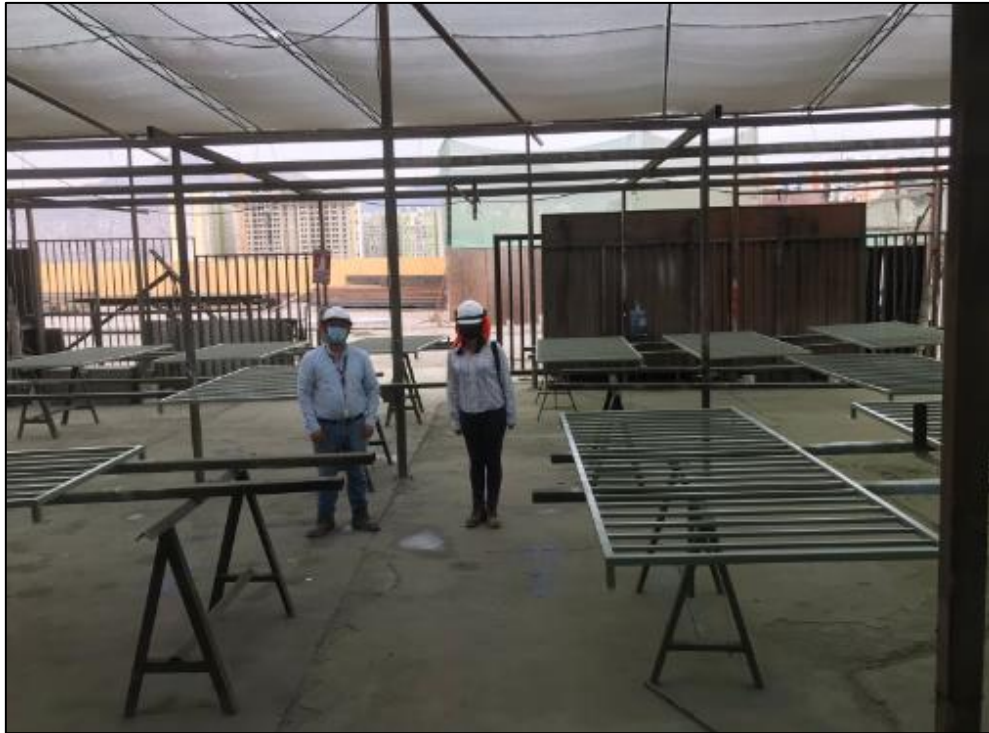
Taller de pintura de Estructuras metálicas. Fuente: proyecto 01
